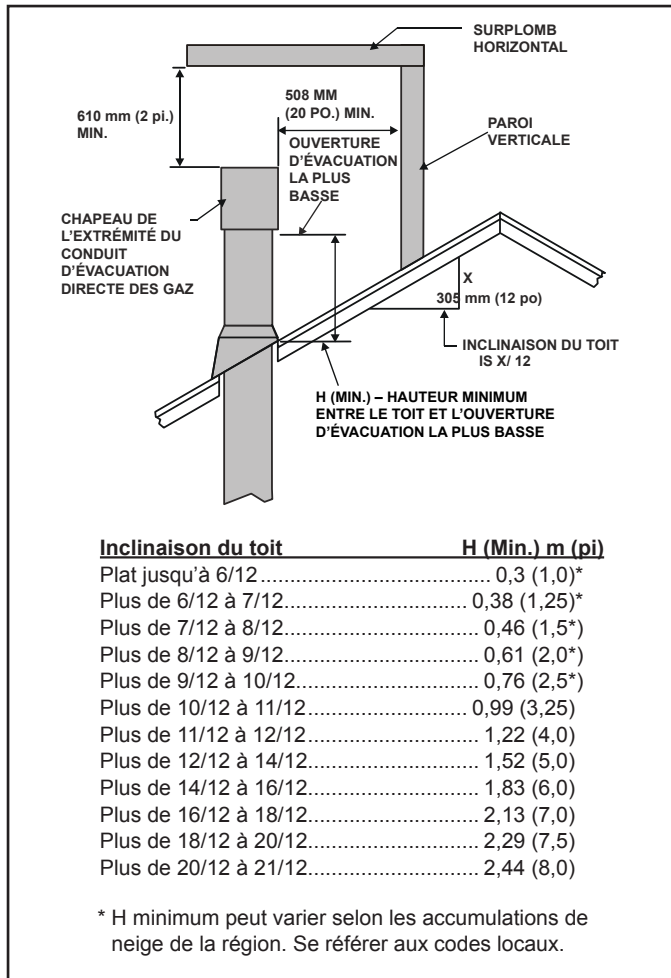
Hauteur minimum entre le toit et l'ouverture d'évacuation la plus basse
